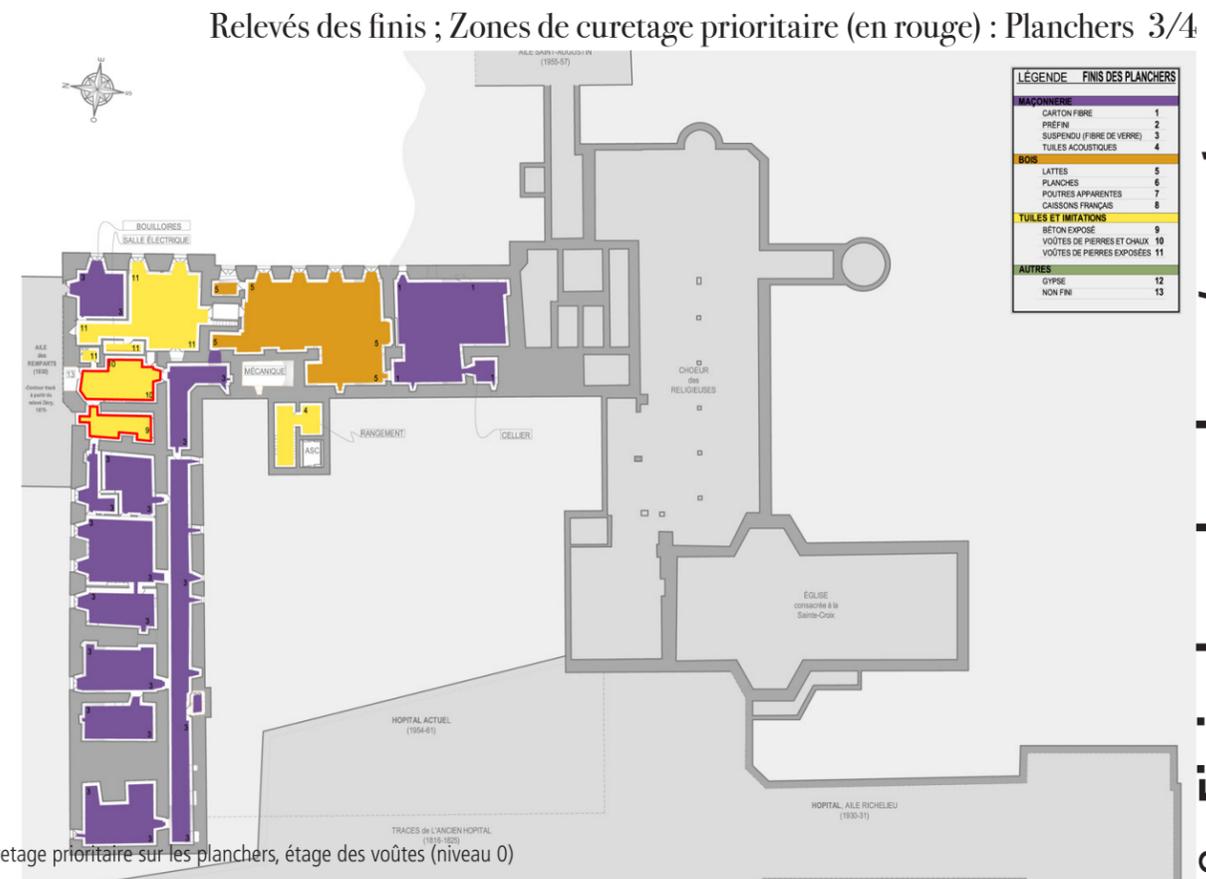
Plan de curetage prioritaire sur les planchers, étage des voûtes (niveau 0)
